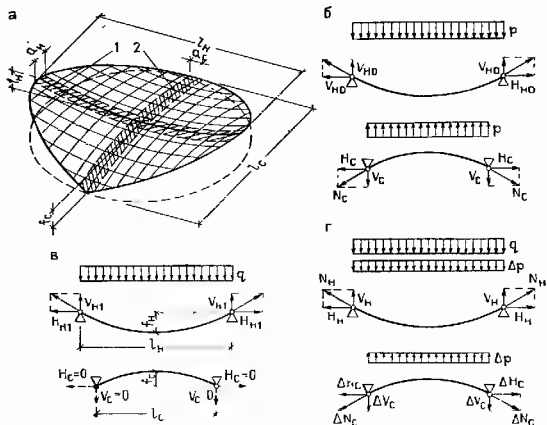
Расчетная схема ортогональной вантовой сети
